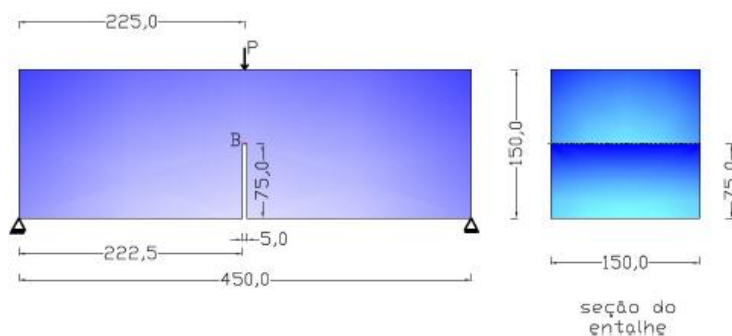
Geometria (mm) e esquema de carregamento das vigas de Araújo (2002) (GROSSI, 2006)
